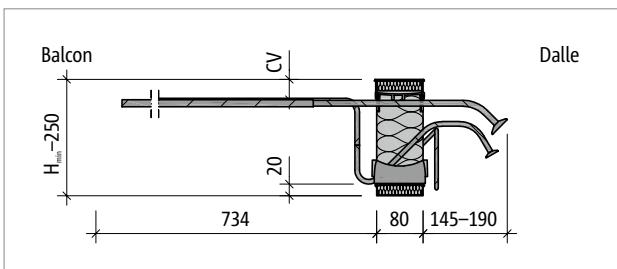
Schöck Isokorb® T type K-O-M4 : coupe du produit
